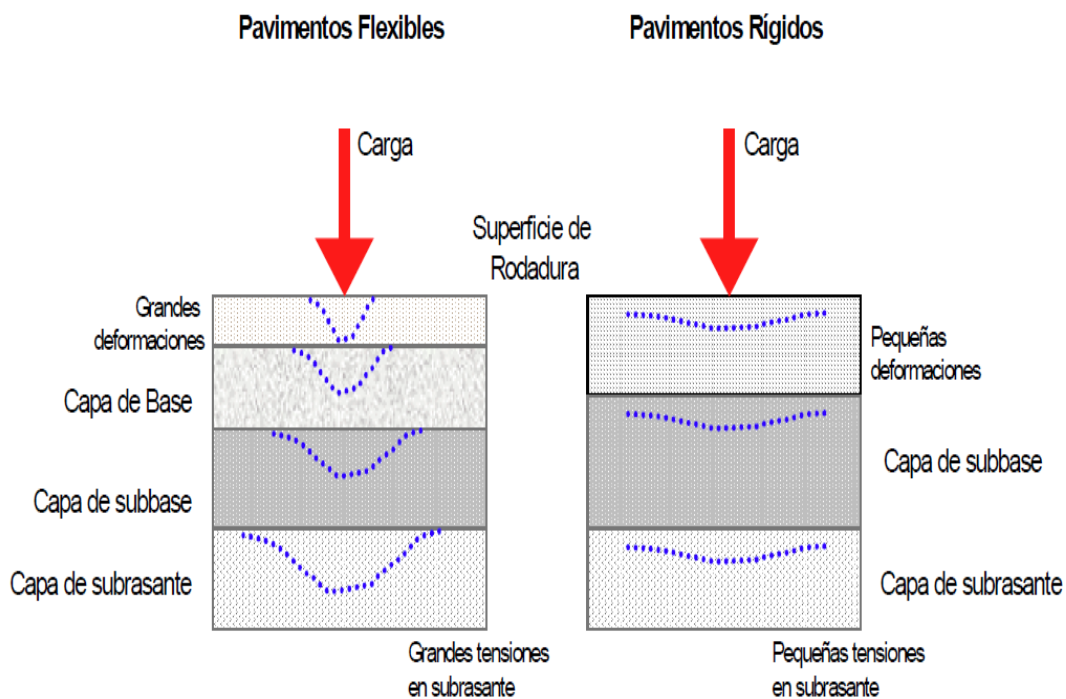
Esquema del comportamiento de pavimentos flexibles y rígidos
